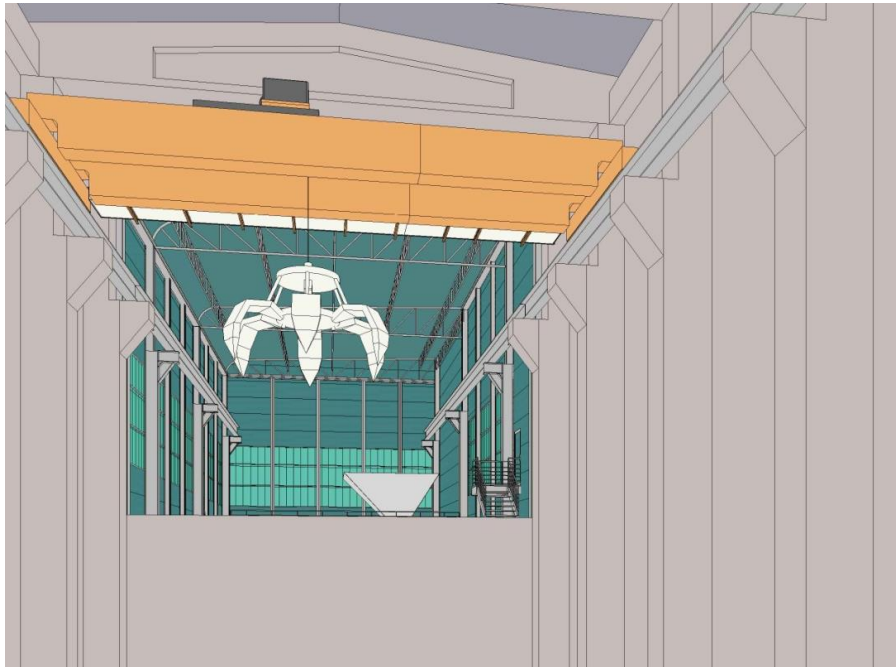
Edificio Fossa: apertura parziale del tamponamento per il passaggio del carroponete – stato di progetto
